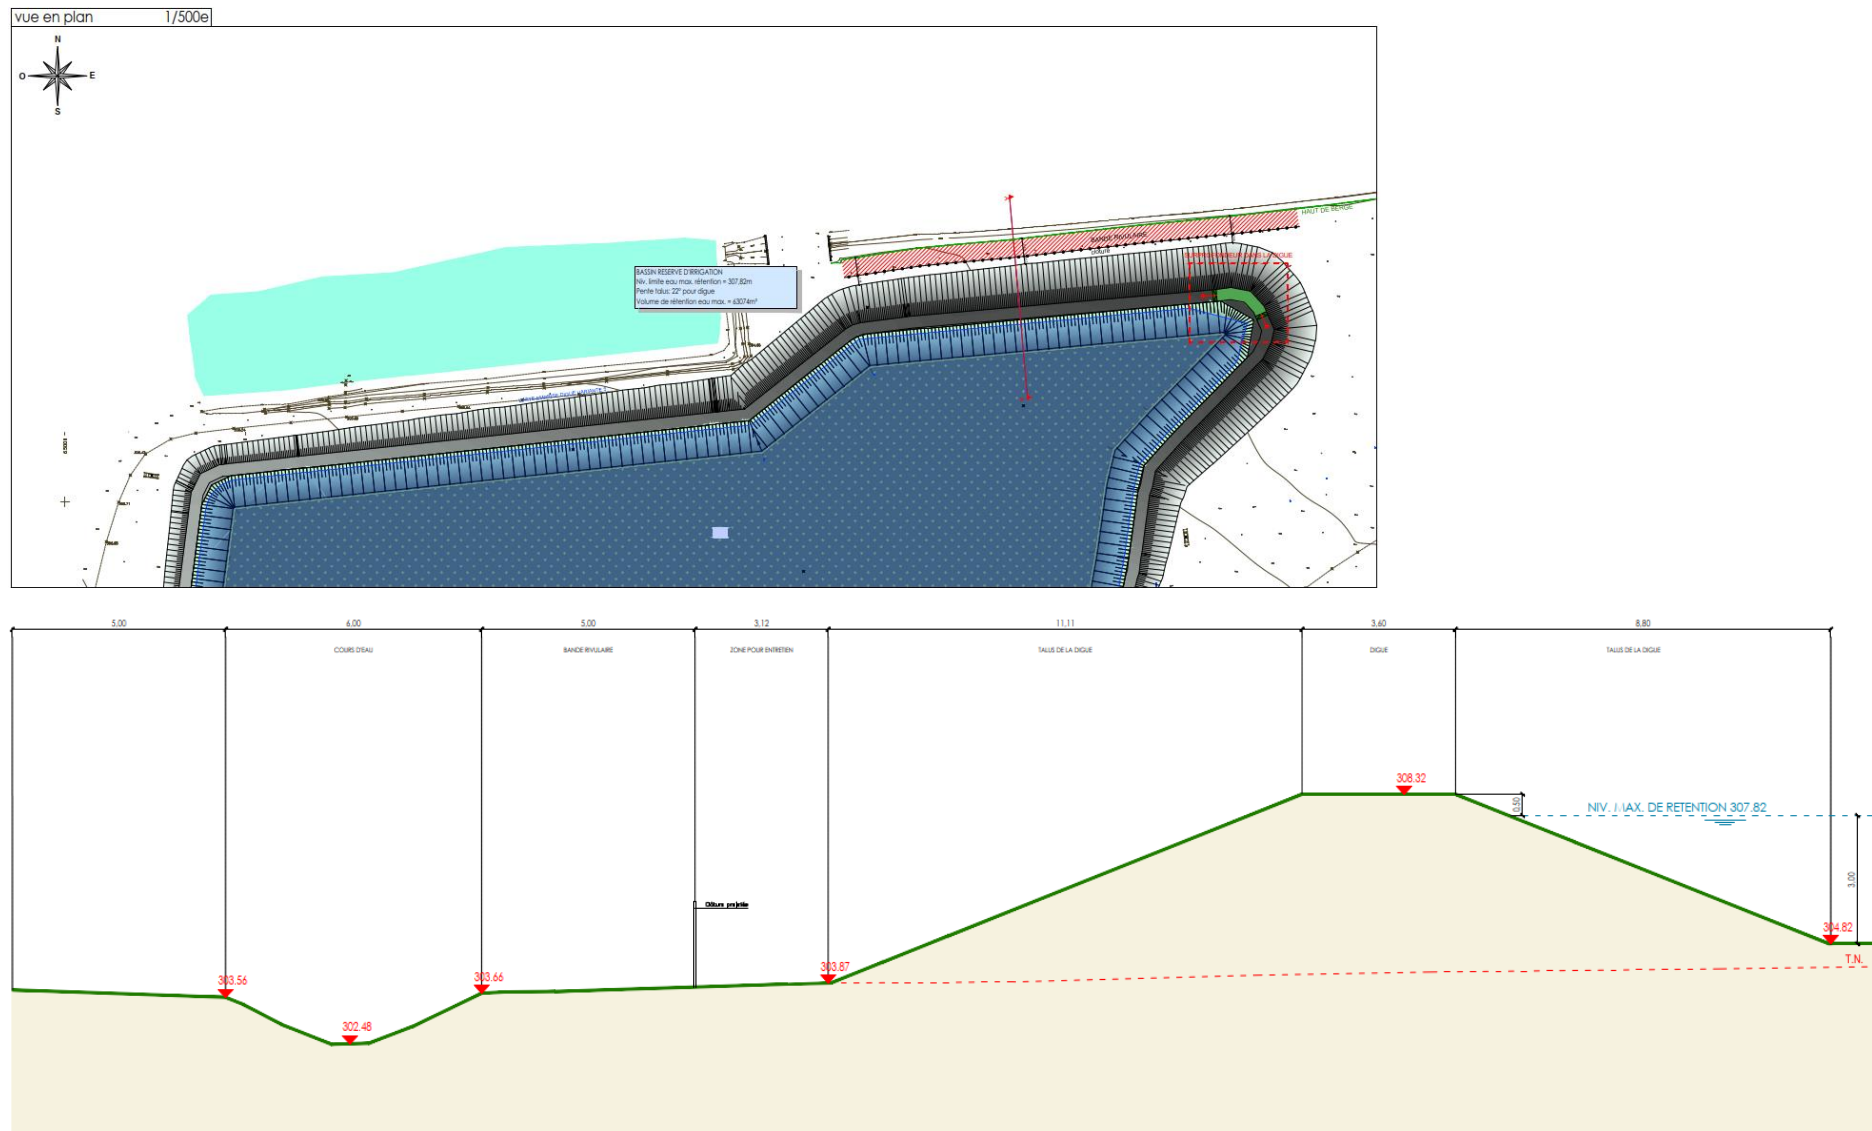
Auszug aus dem Plan „Déplacement du Ruisseau – Coupe dans Talus“: Profilschnitt durch die nördliche Böschung und den benachbarten Klausbach (LUXPLAN S.A. 02/2024).
